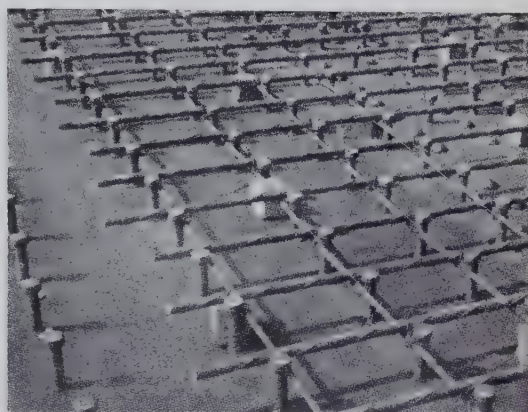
Fahrbahnblech mit „Nelson“-Bolzen und Stahlbewehrung
